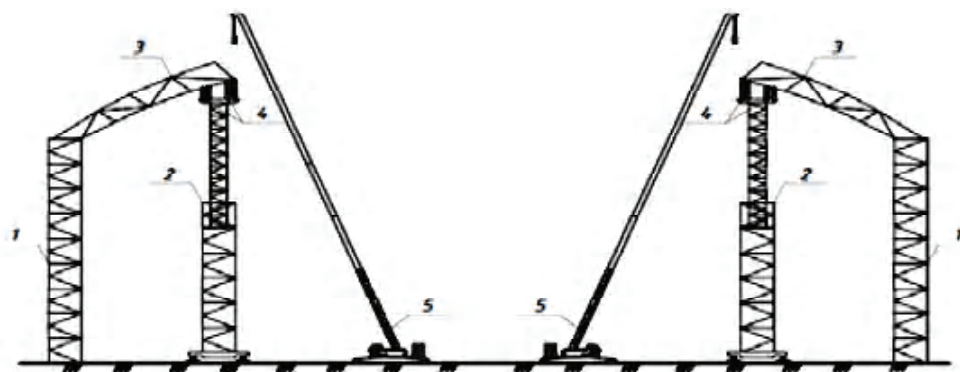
Монтаж элементов арки краном с промежуточными опорами: 1 – колонны здания; 2 – промежуточные опоры; 3 – монтажные блоки арки; 4 – домкратные устройства; 5 – монтажные краны.
